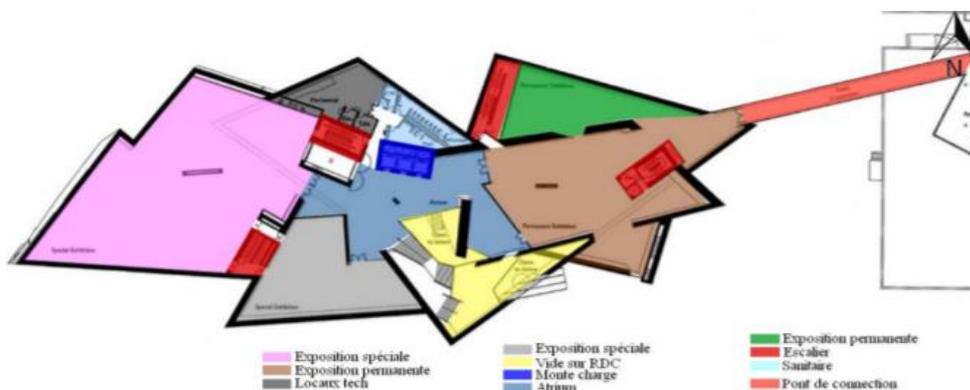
Plan 1er étage. Source : www.archdaily.com, édité par l'auteur
